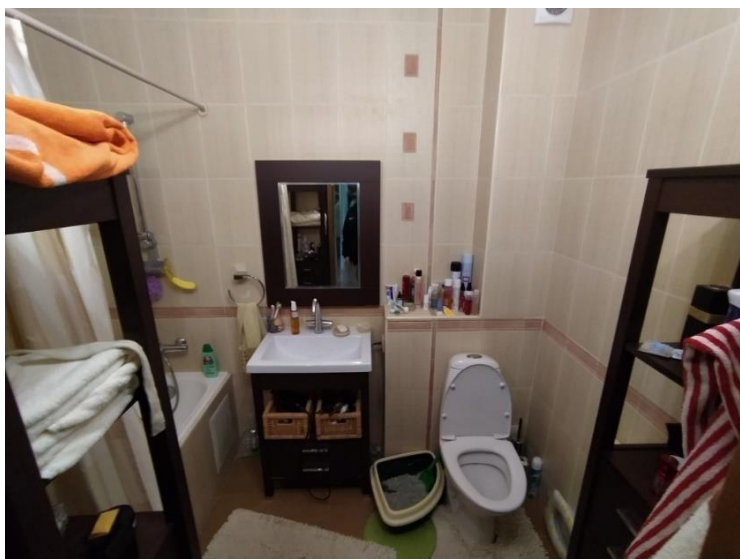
Фрагмент вида помещения № 5 (Санузел).
